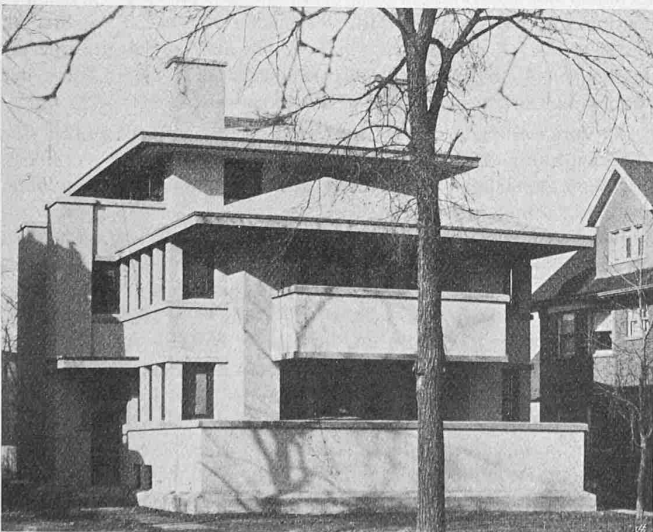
Typus eines amerikan. Beton- und Eisenbeton-Hauses.
